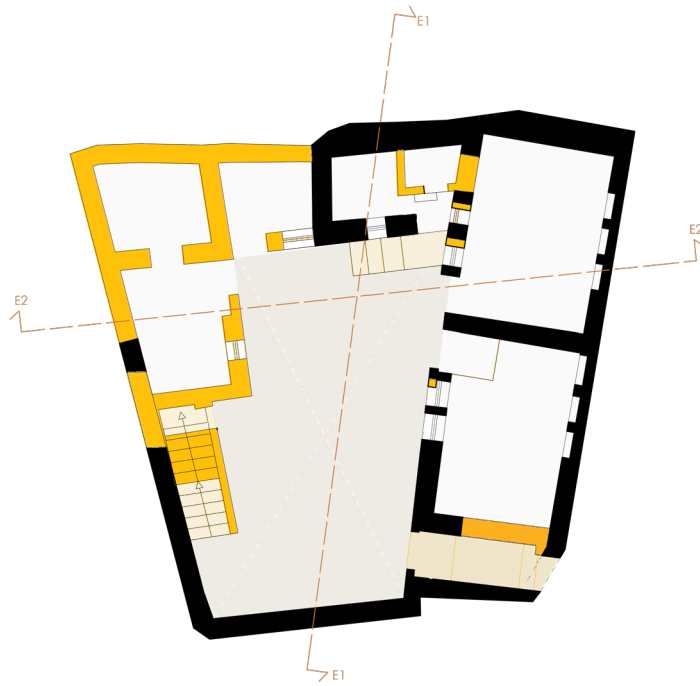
Interventi di distruzione al piano terra | Scala 1/200
